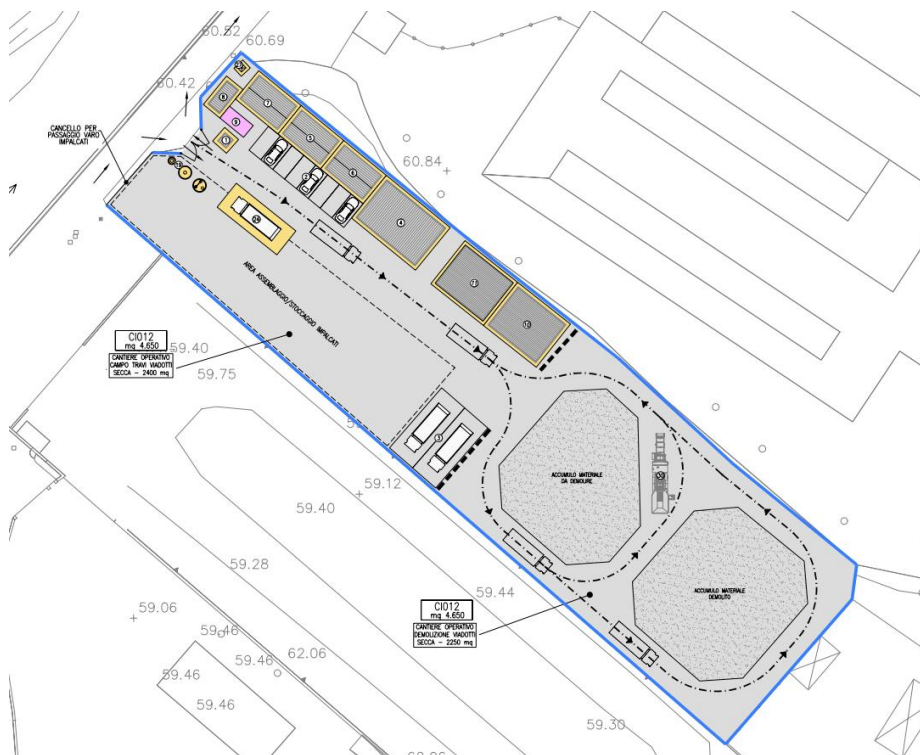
Layout del campo CI012 – apprestamenti di cantiere
